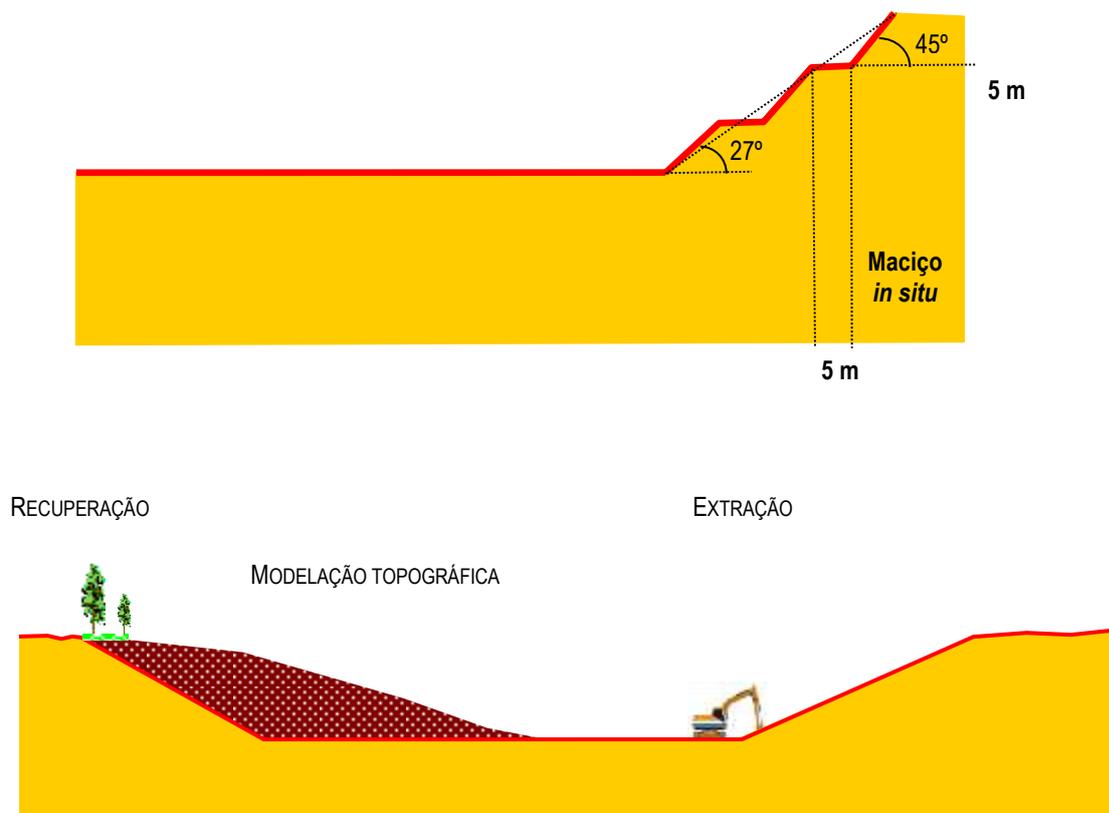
Perfil esquemático da configuração final de escavação e modelação.
